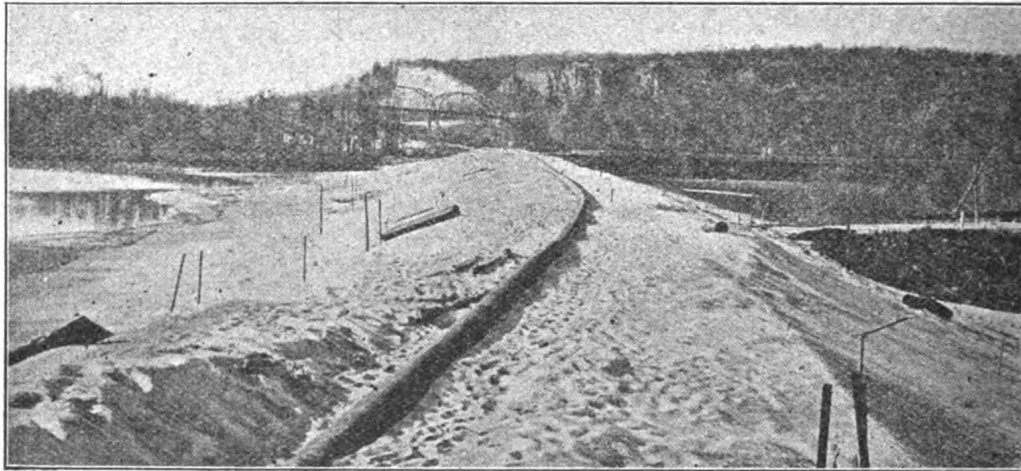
Bau einer 2 km langen Straße durch den Sunfish-See: Der fertige Damm vor der Verkleidung mit Weiden und Steinen.
